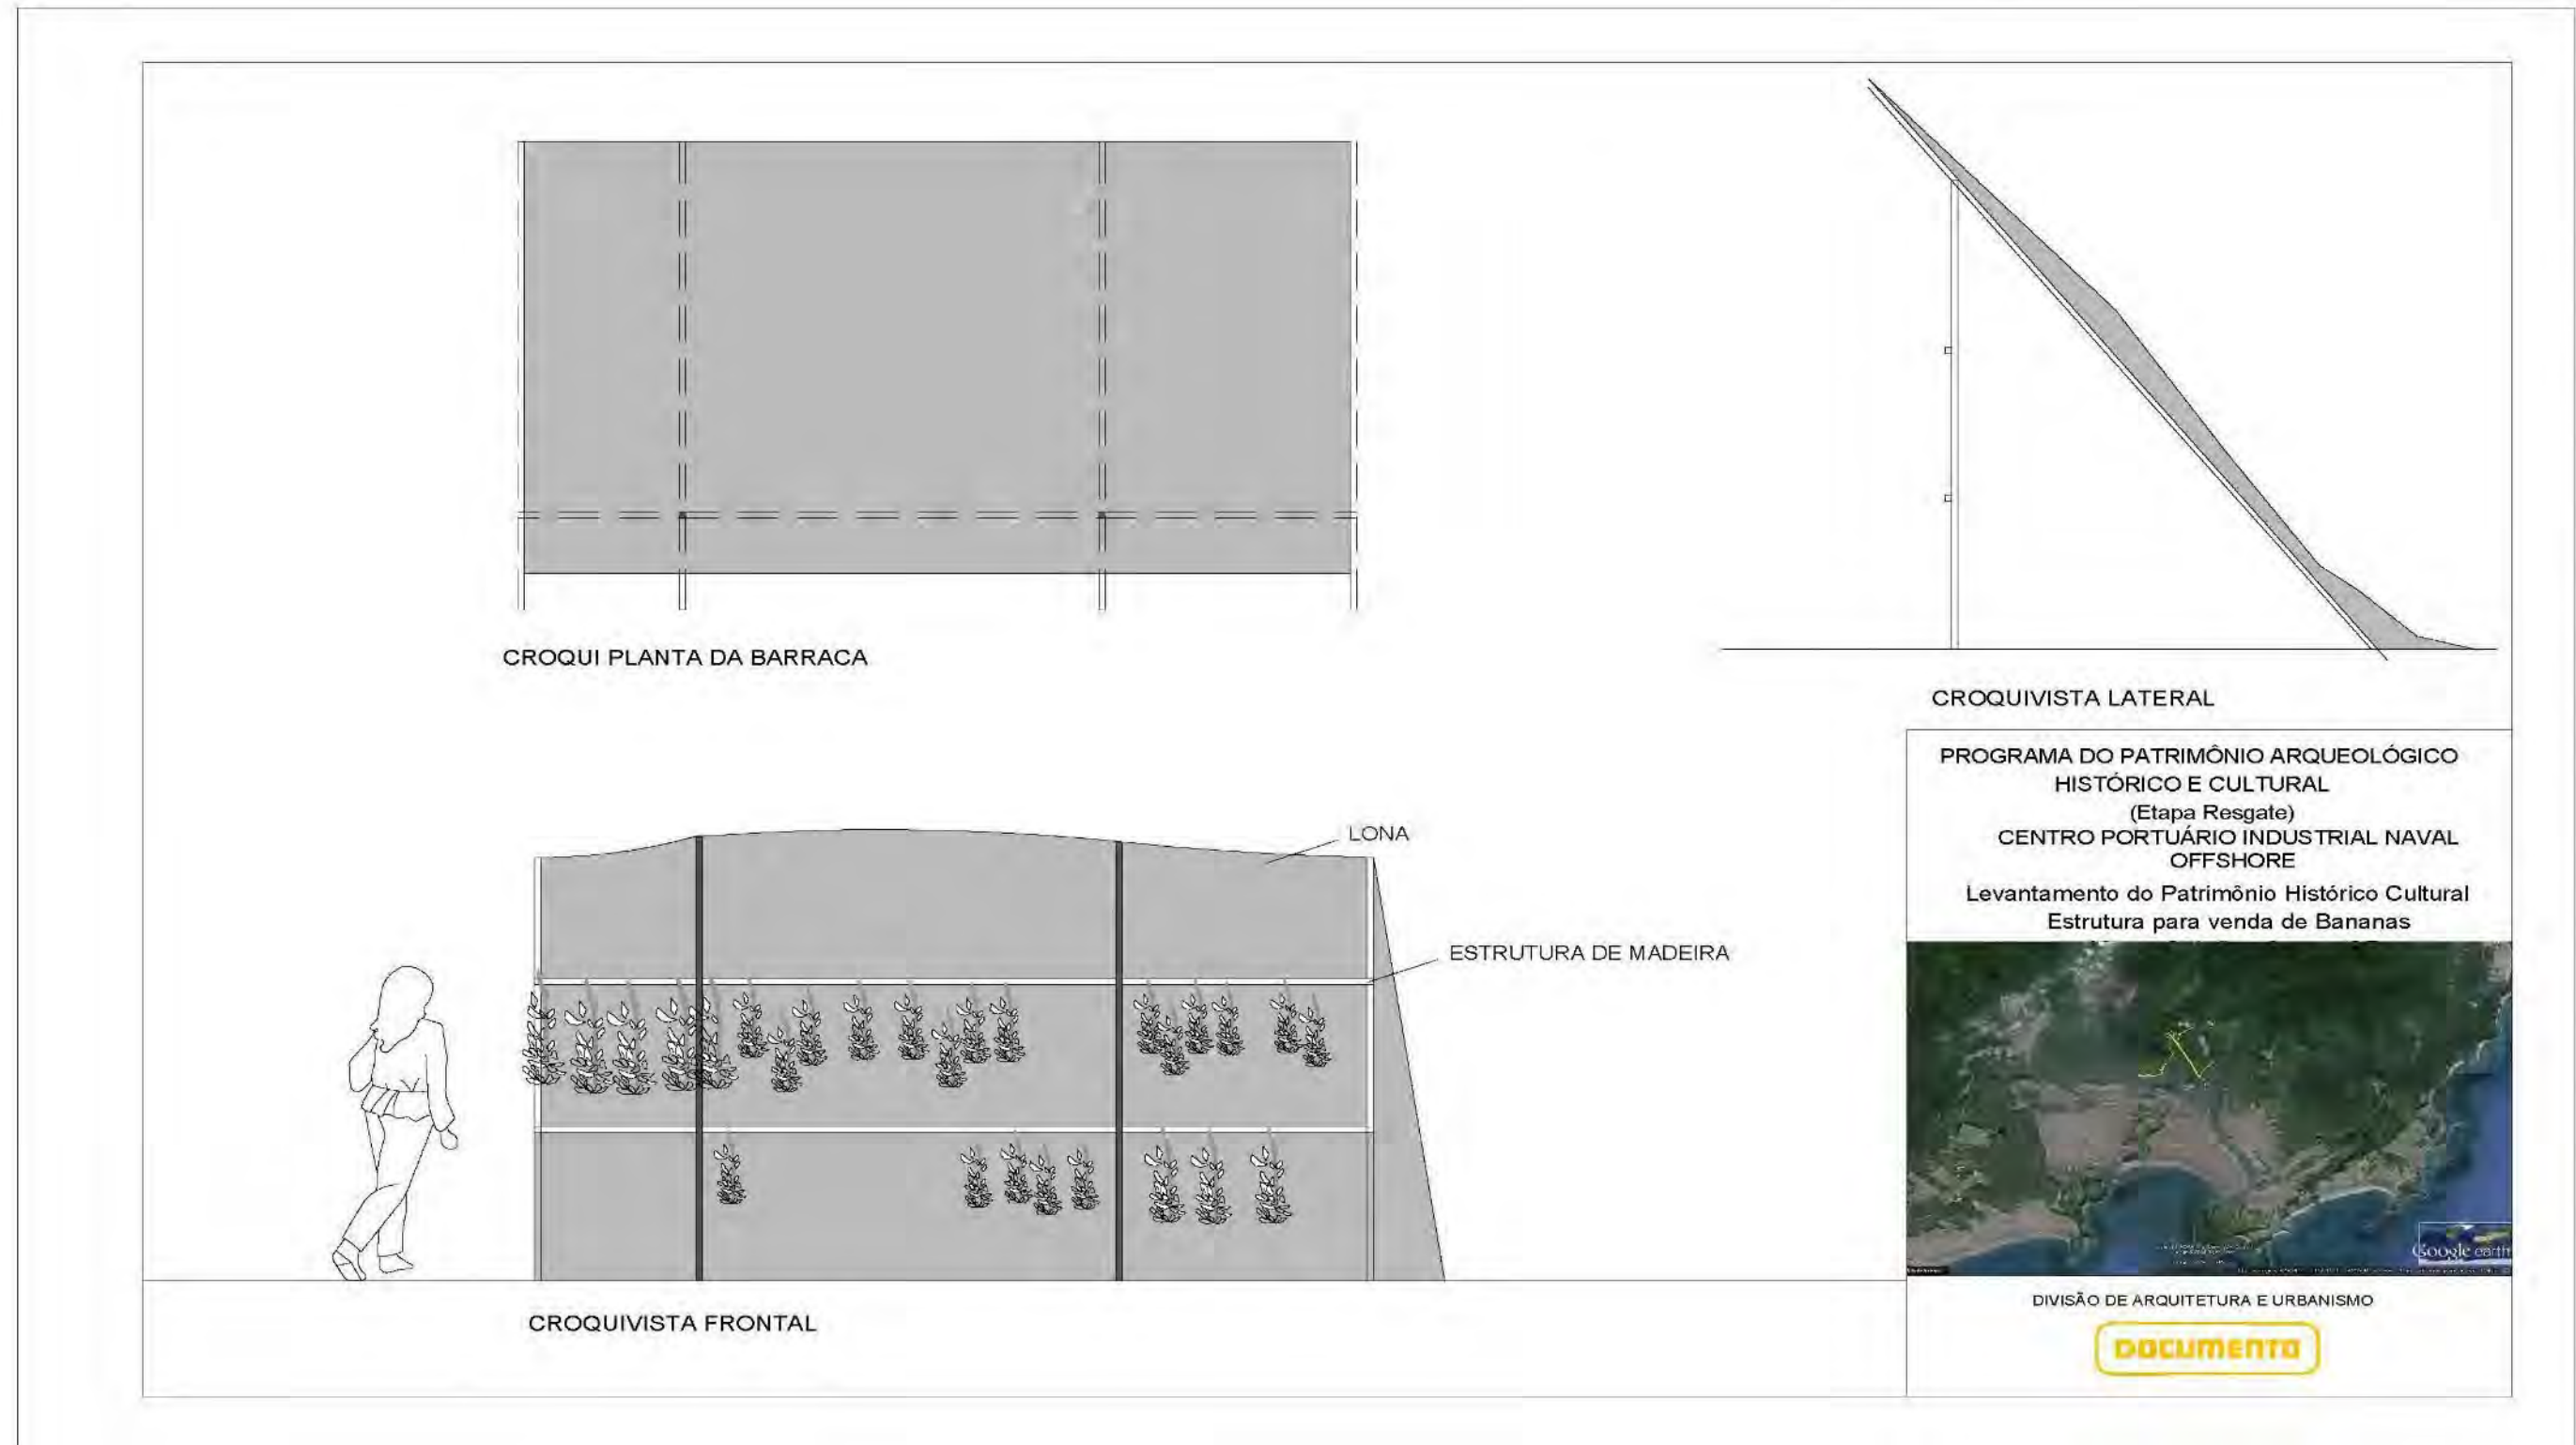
Planta - Arquitetura de Edifício Bananeiras.
